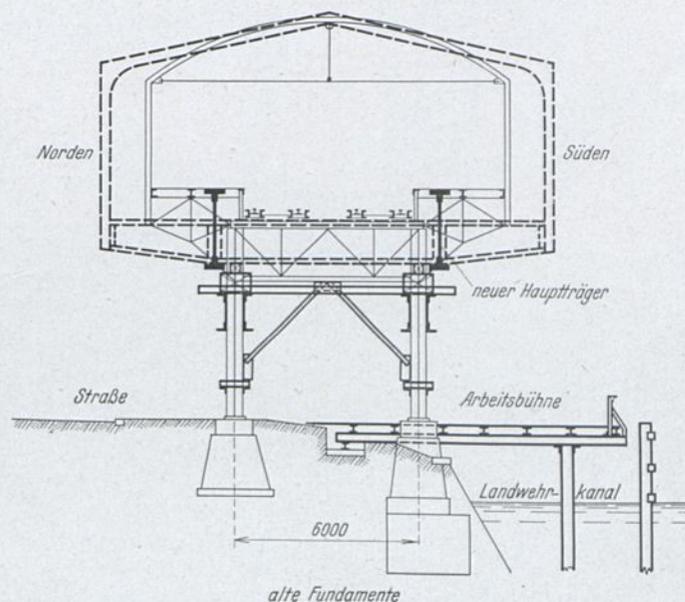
Querschnitt durch die Montagerüstung und die Hallen des alten und neuen Bahnhofs.
